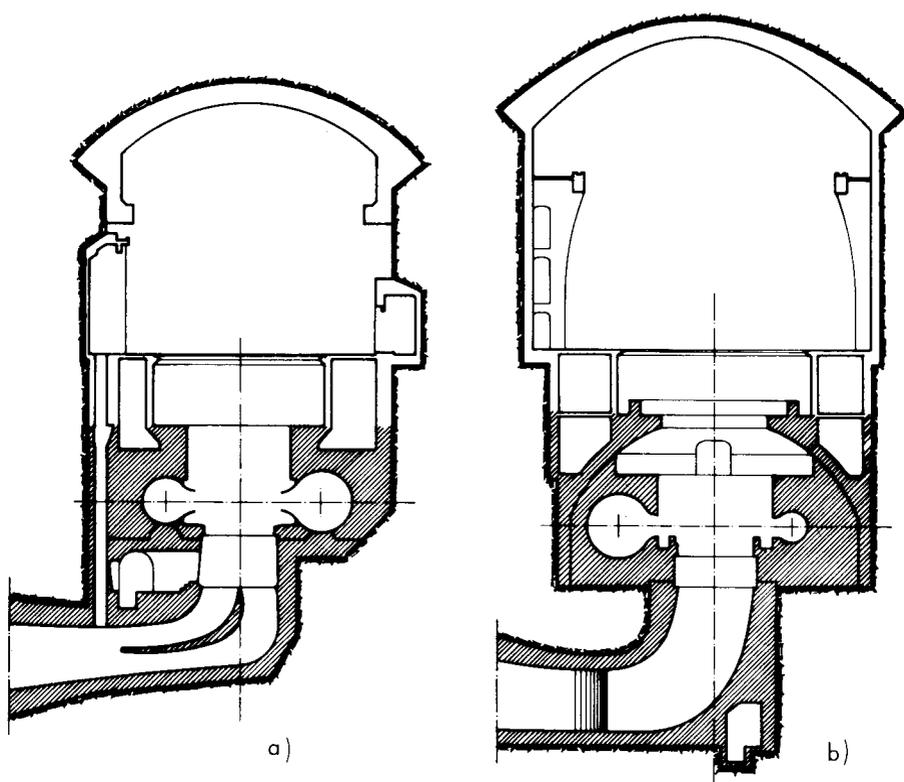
Estrutura de betão do envolvimento e suportes dos grupos geradores (servem de entravamento das paredes): a) Picote; b) Miranda
